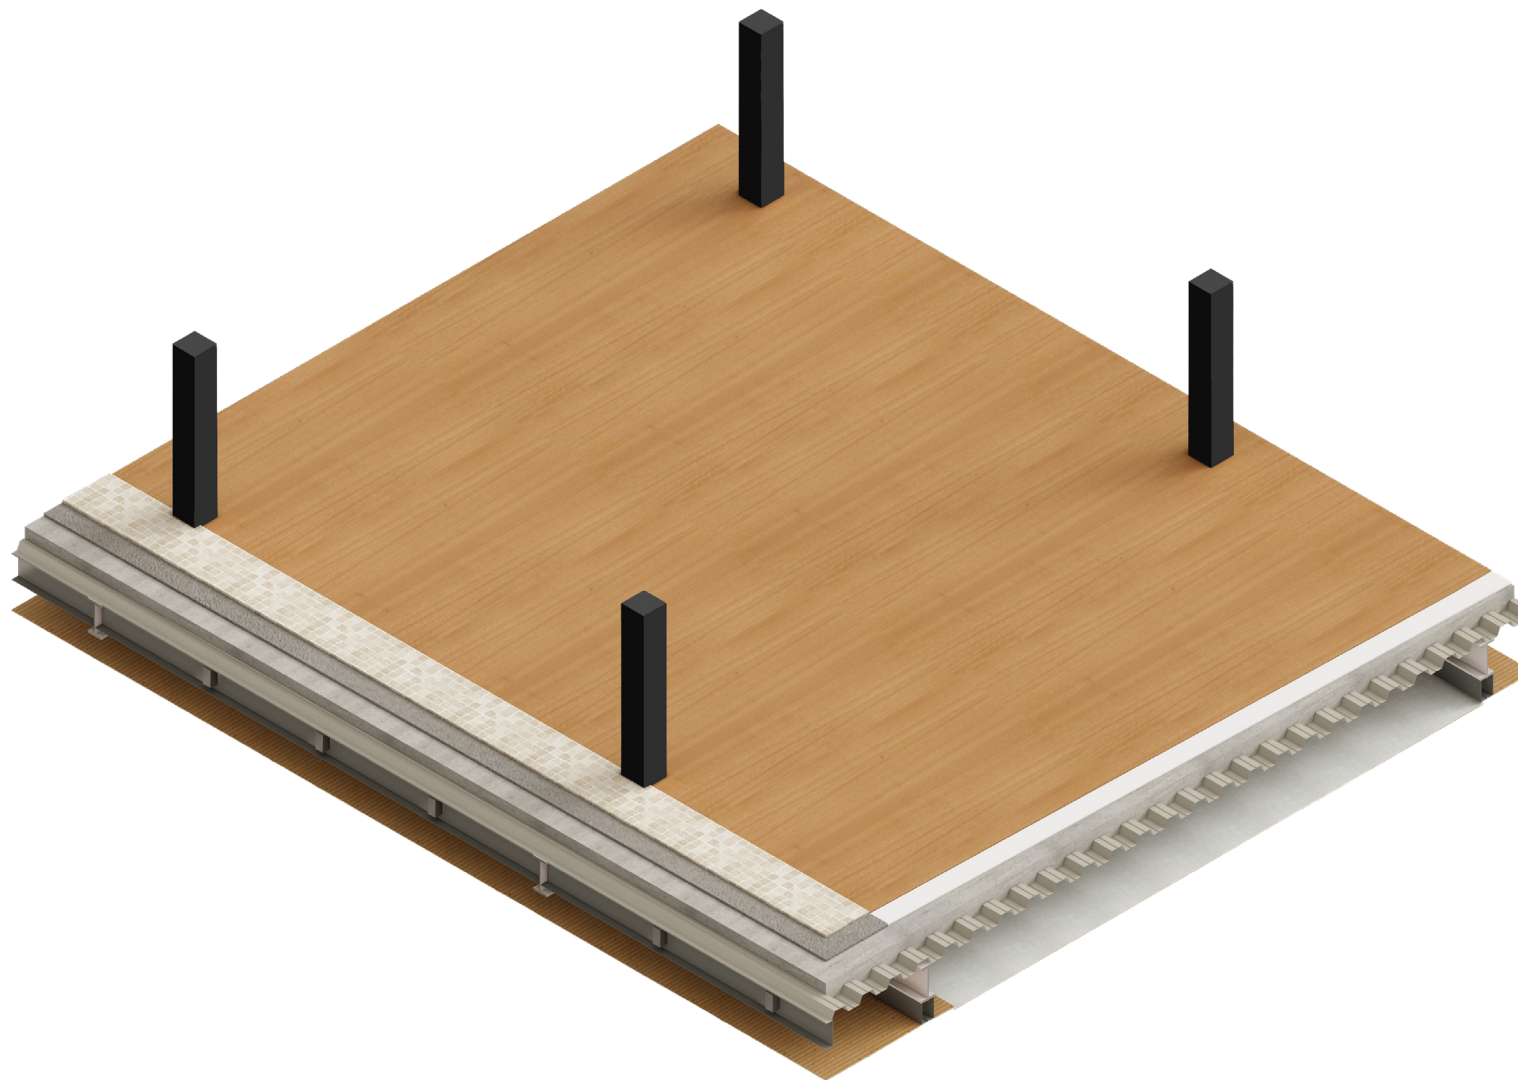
Axonometría por capas del entrepiso. Nota. Elaboración propia.
